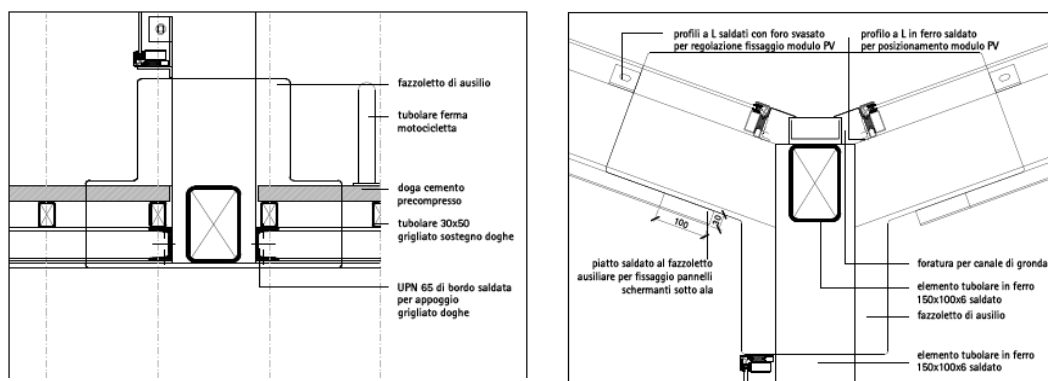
Sezione longitudinale del piede e dettaglio fazzoletti ausiliari.
